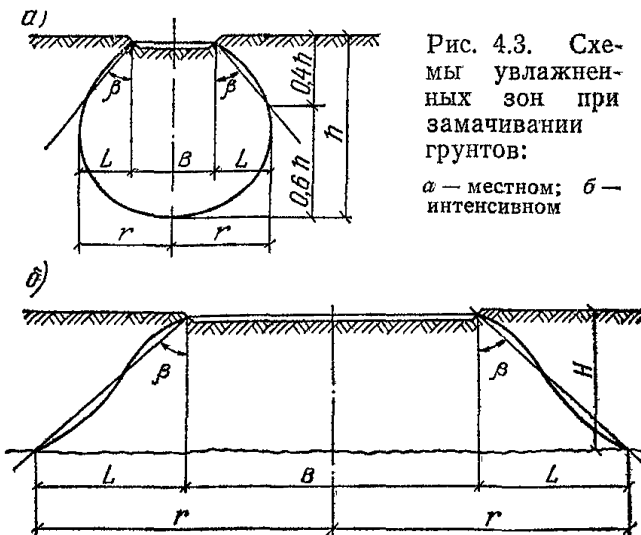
Схемы увлажненных зон при замачивании грунтов:
